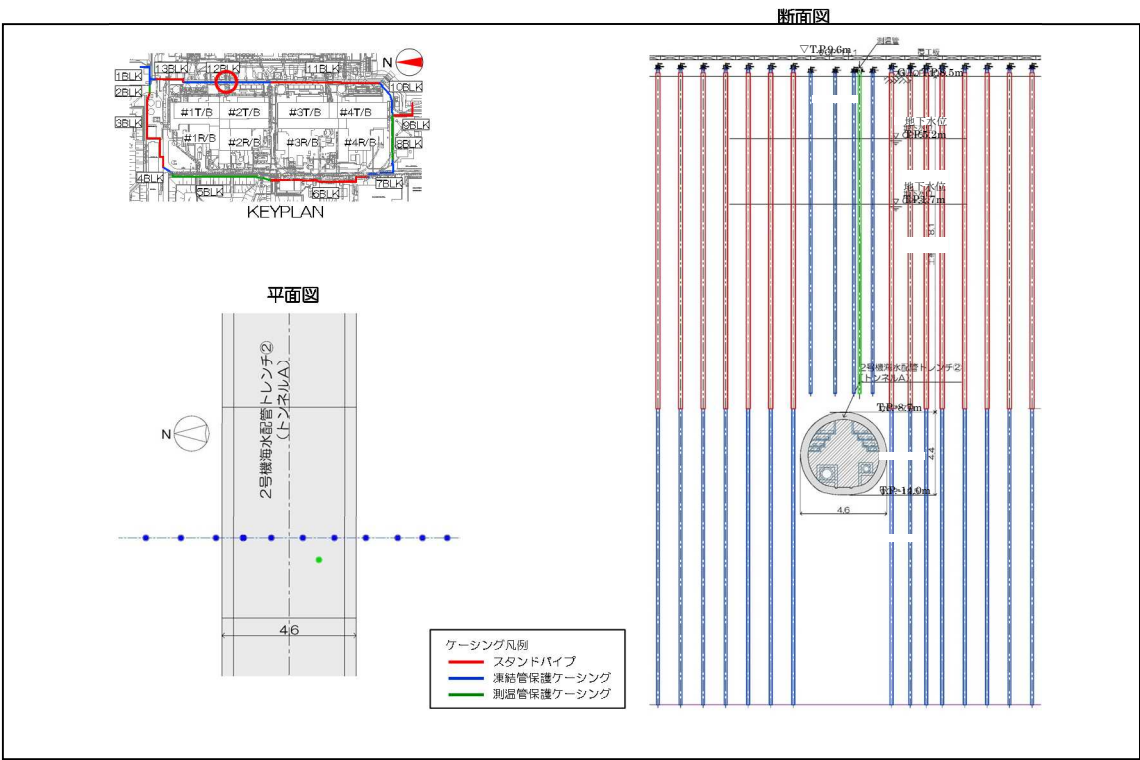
2号機海水配管トレンチトンネルA部 施工平面図・断面図
